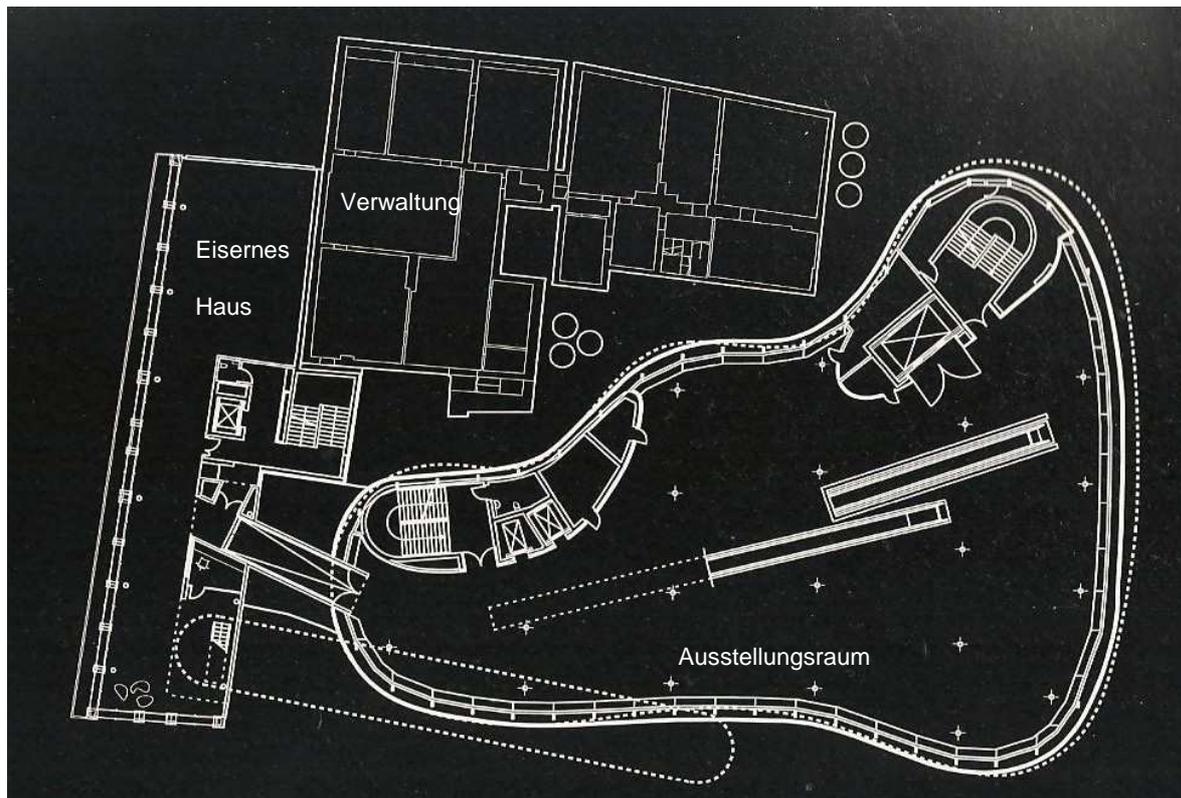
Kunsthaus Graz, Grundriss 2. Obergeschoß 1:500
